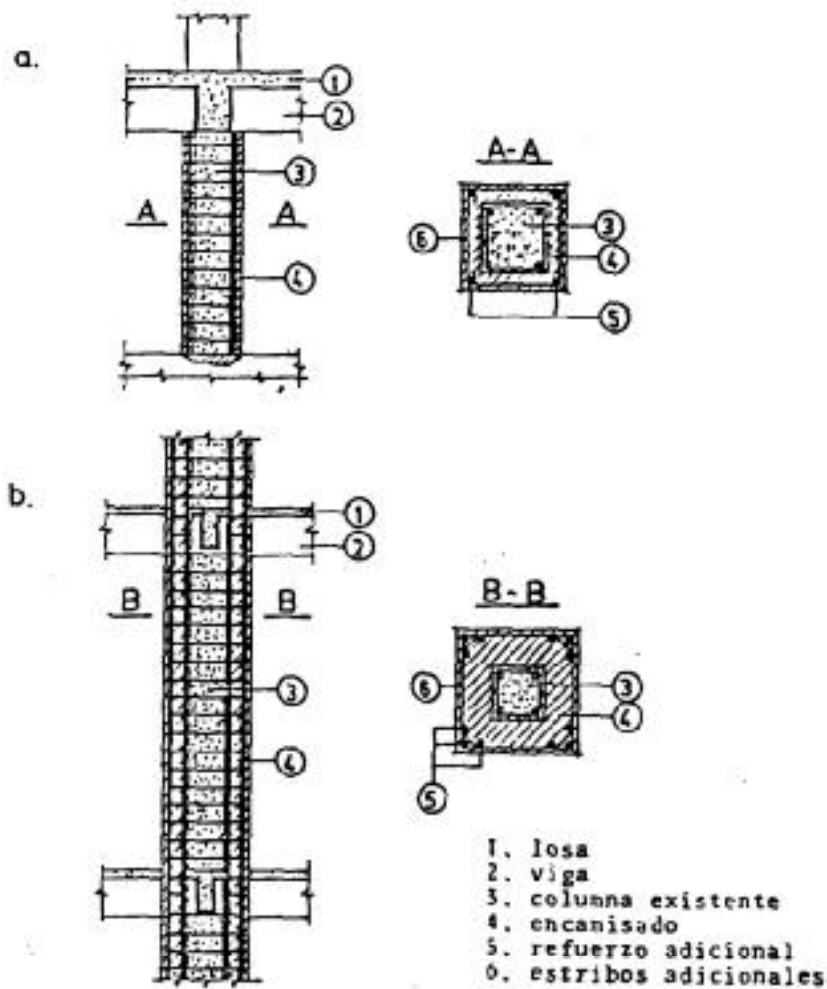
Encamisado de columnas con concreto reforzado (ref. 1)
